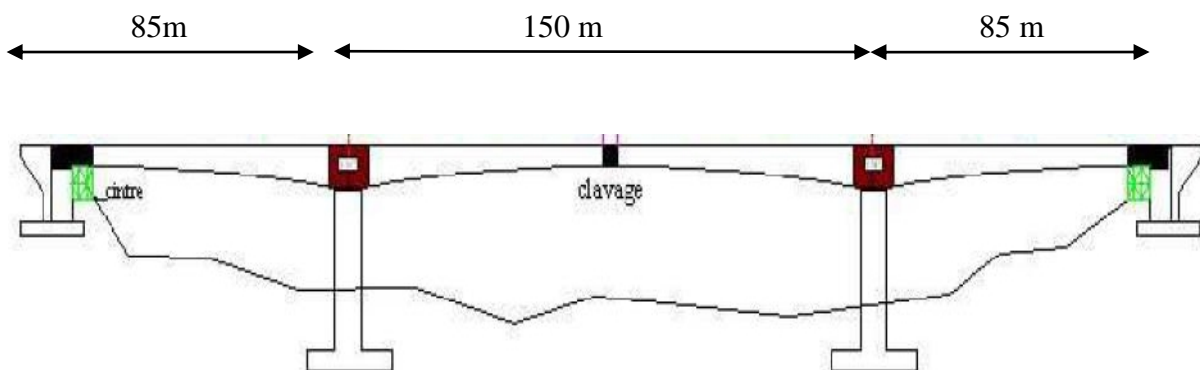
Coupe longitudinale de l'ouvrage.
